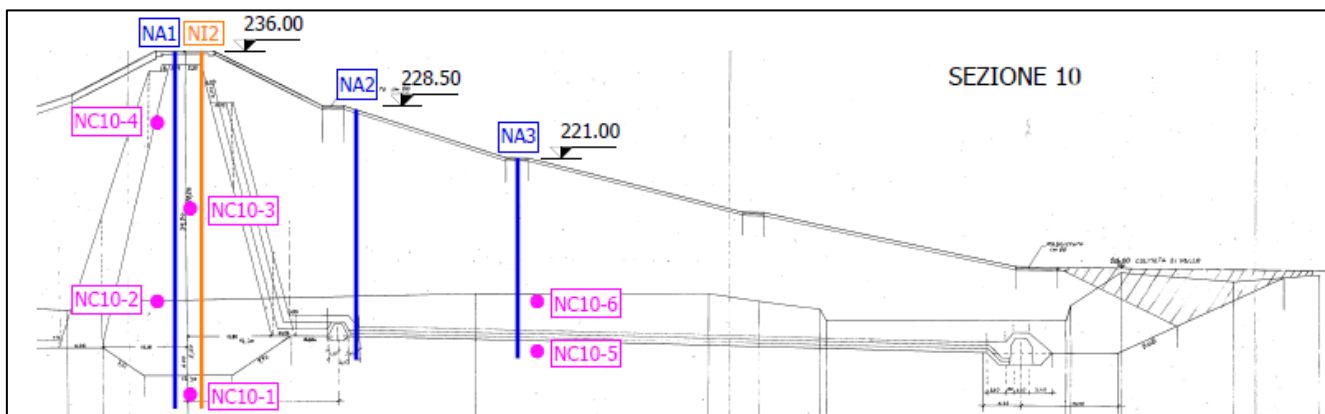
Posizione della nuova strumentazione nel corpo diga – Sezione 10
